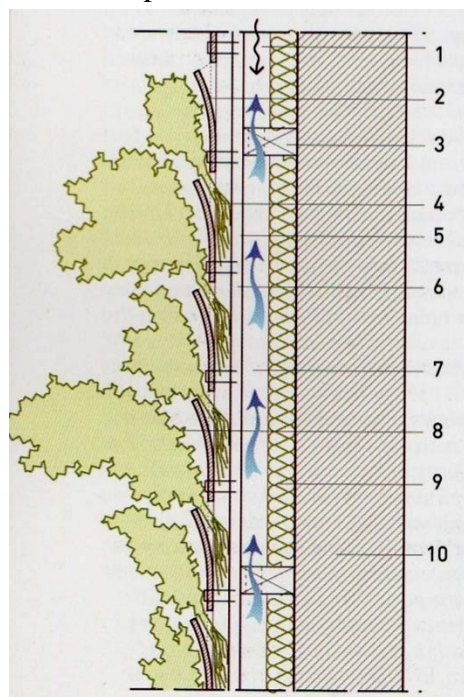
Corte explicativo de uma Parede Viva Hidrópica:
